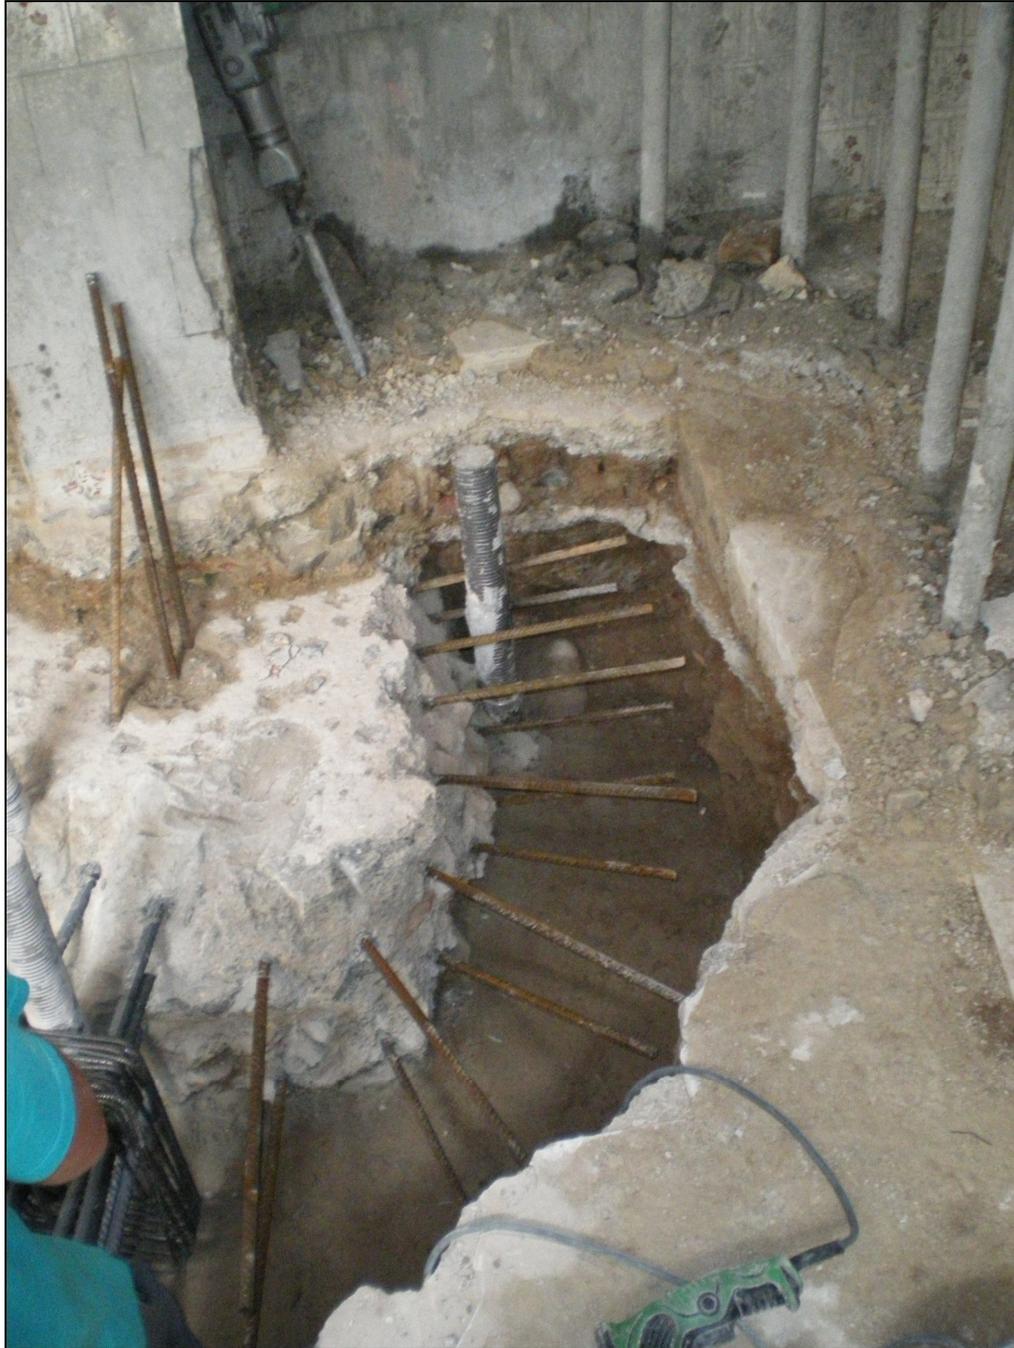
Anclado con resinas epoxi de las armaduras de espera en la zapata más afectada.
